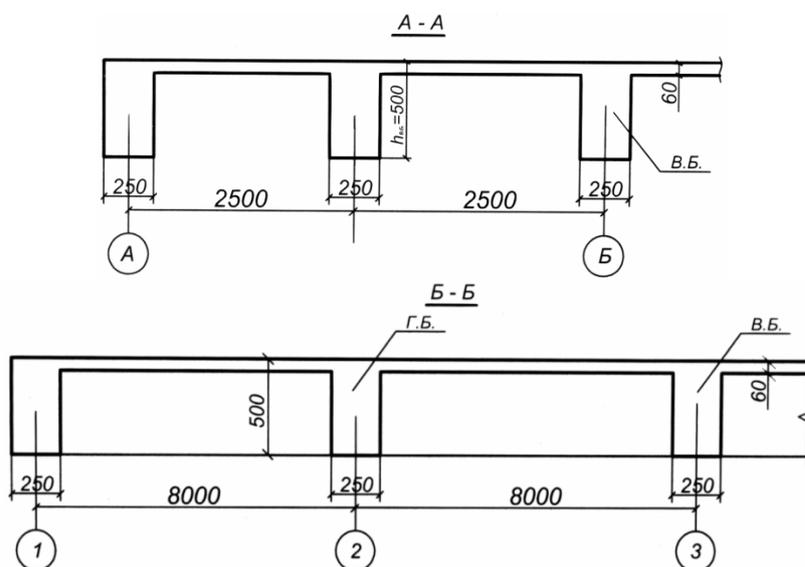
Размеры сечений конструкций монолитного перекрытия.
